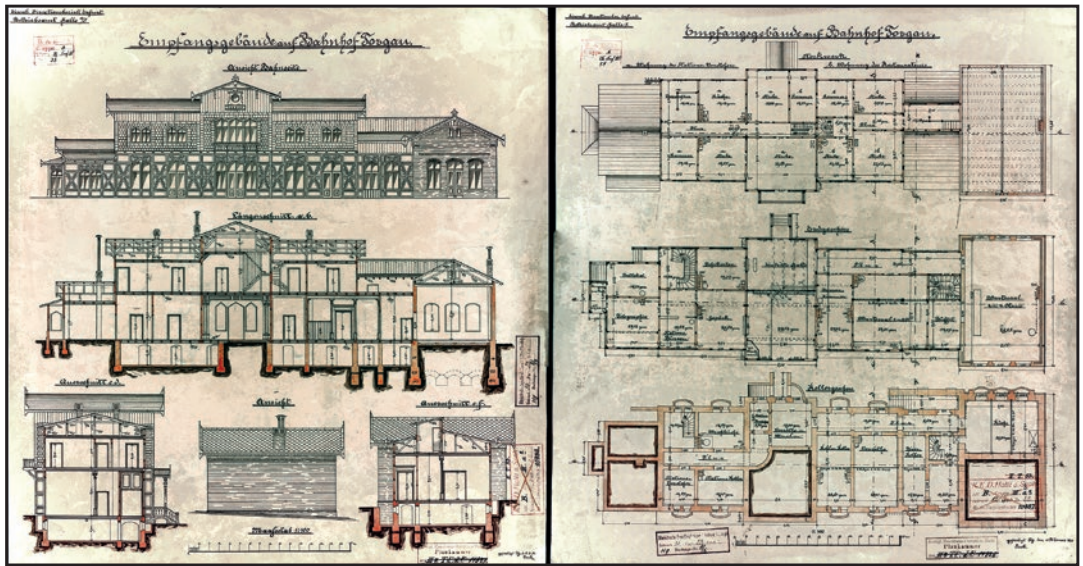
Bau- und Grundrissplan von 1868 zur Errichtung des Bahnhofsgebäudes Torgau.
